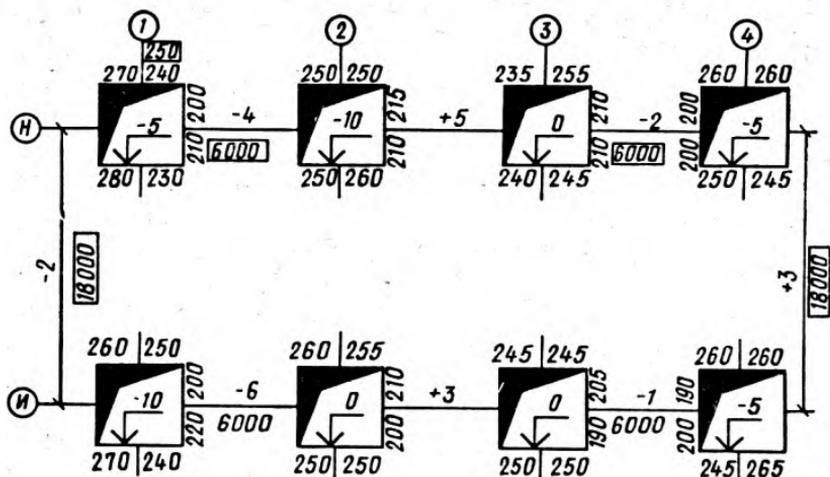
Исполнительный чертеж плано-высотного положения стаканов фундаментов под железобетонные колонны
